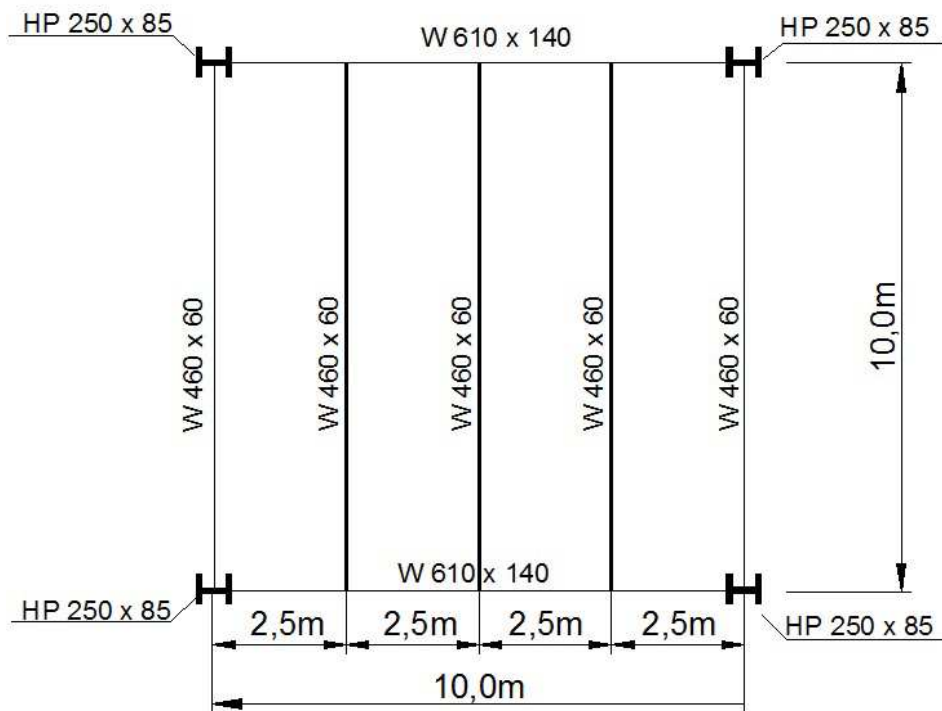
Planta baixa genérica do pavimento do piso em estudo.
